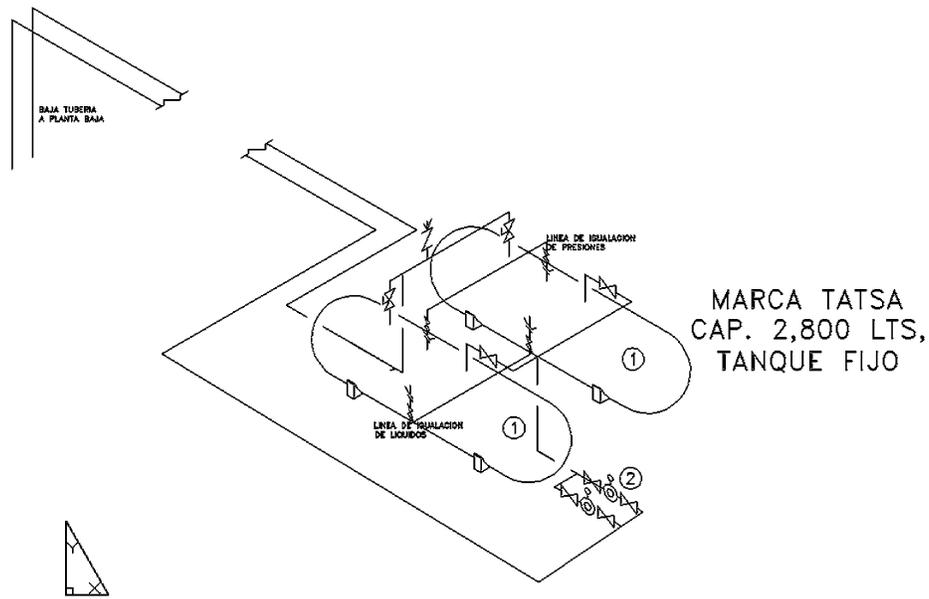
Detalle de Instalación de los tanques de gas LP que serán instalados en la azotea del proyecto.
